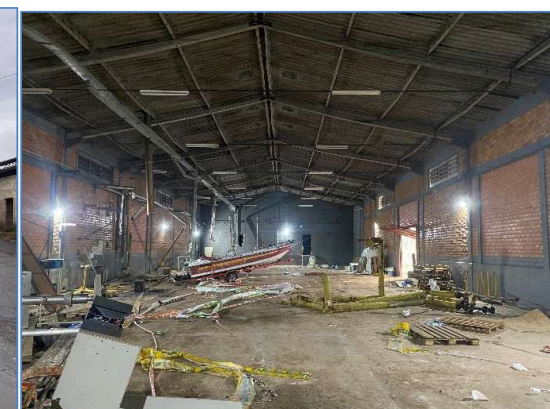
vista interna do galpão/barracão, mau estado de conservação.
